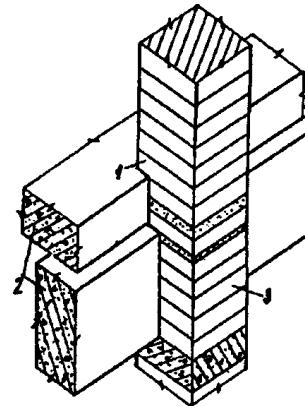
Неправильное опирание кирпичного столба в уровне перекрытия: часть сечения столба (1) опирается на железобетонную конструкцию перекрытия (2), часть — на кирпичную кладку (3)
